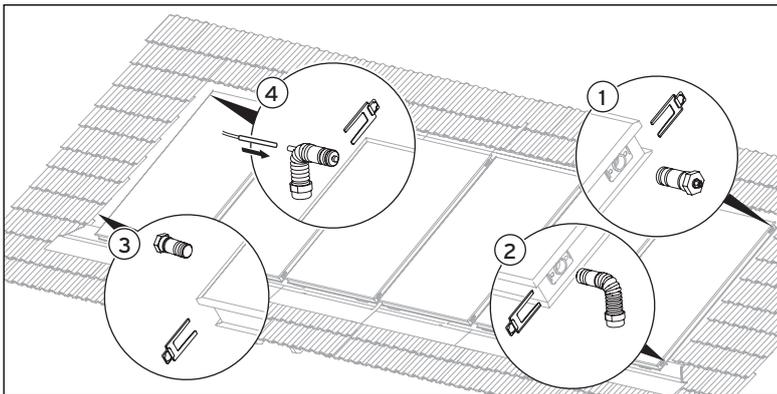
Hydraulische Anschlüsse montieren (6-12 Kollektoren)
